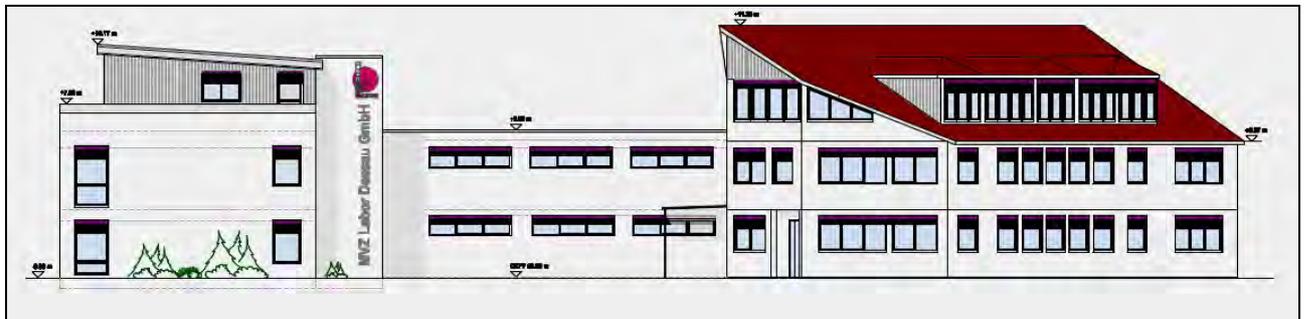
Straßenabwicklung des Erweiterungsbaues mit Staffelgeschoss (links) gegenüber dem Haupttrakt (rechts). Obwohl der Haupttrakt visuell wie ein dreigeschossiges Gebäude wirkt, gilt es wegen der „Zwei-Drittel-Regel“ der alten Bauordnung Sachsen-Anhalt als zweigeschossig. Vergleiche hierzu auch Zeichnung-BI.-Nr. 5. (Entwurf und Zeichnung: RIK – Kathleen Gerth)
